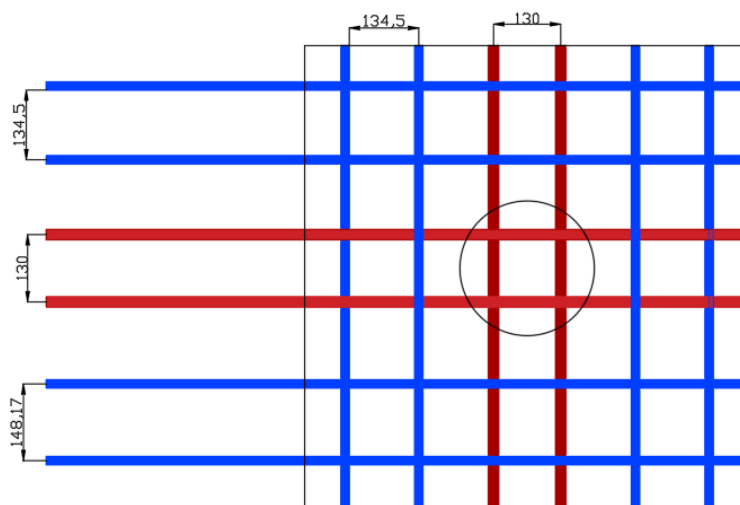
Armadura Pila 4 con 16 micropilotes, Transversal y longitudinal, Espaciado entre las diferentes barras
